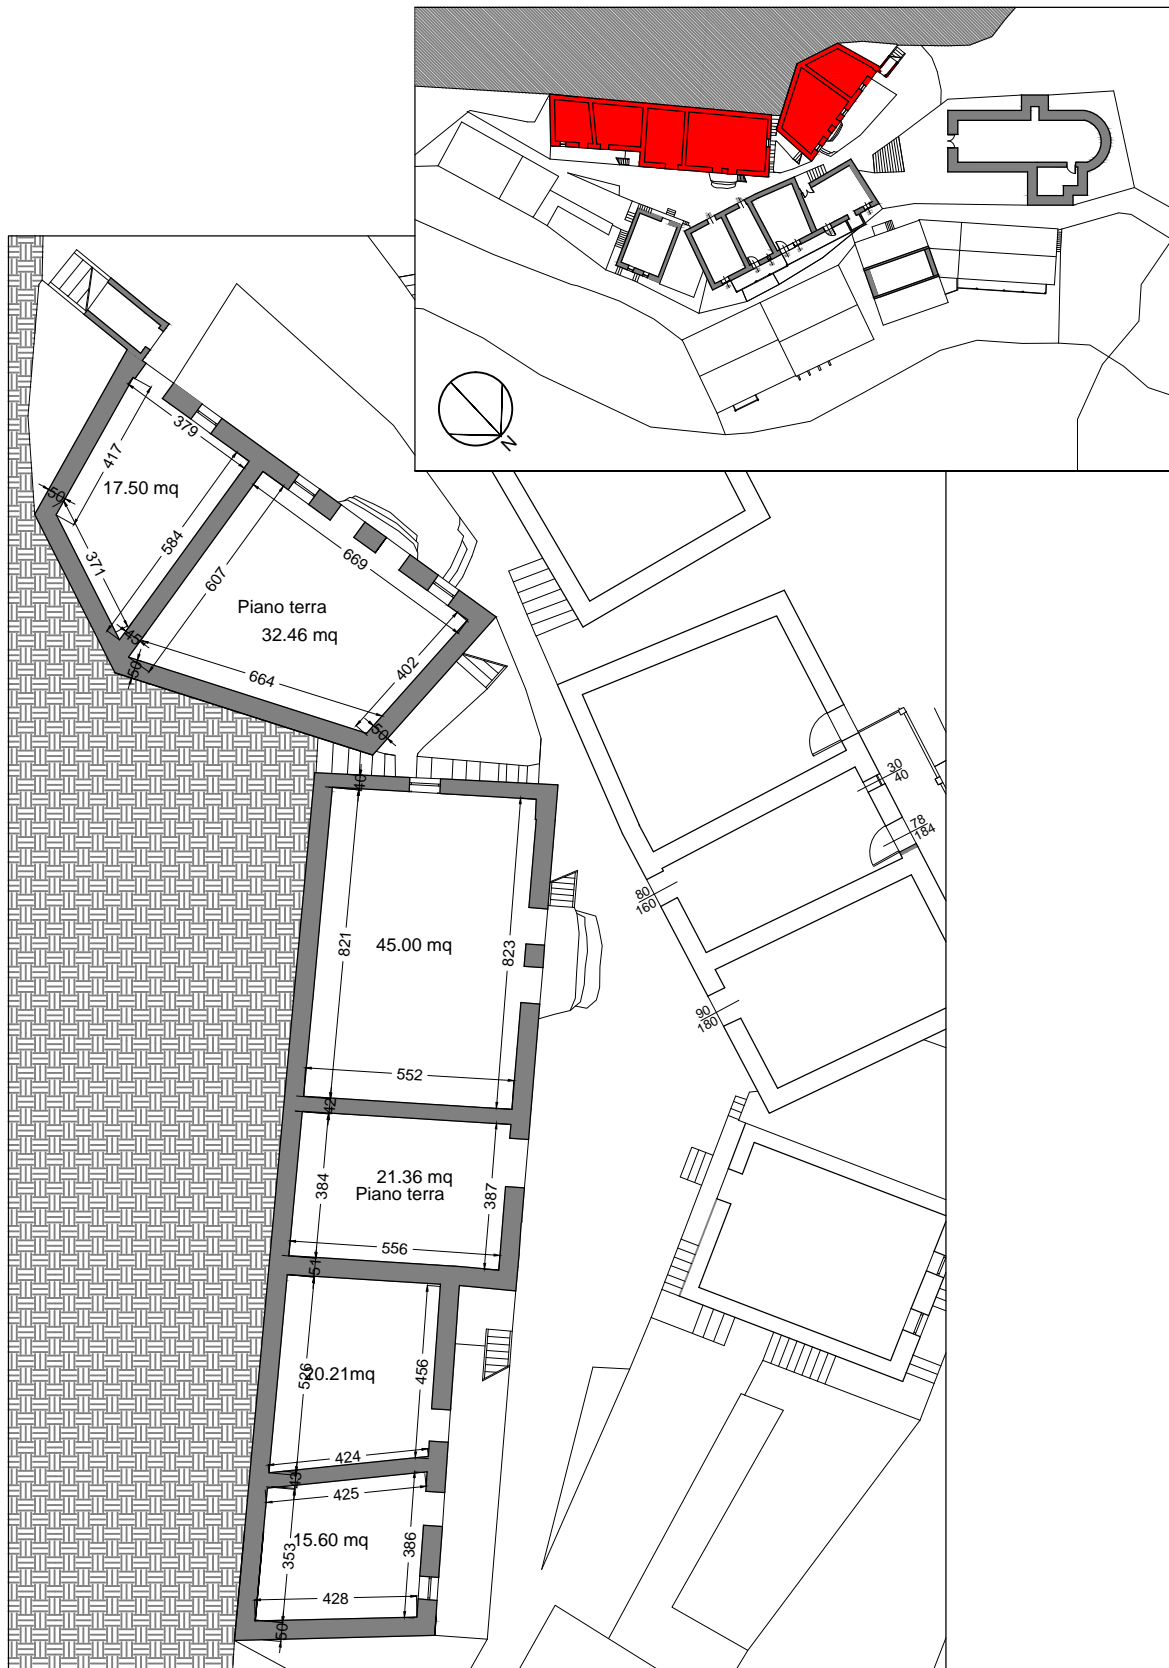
pianta in scala 1:200 degli edifici 95-96-97-101-102-103-106-107 alla quota di 7,50 m
